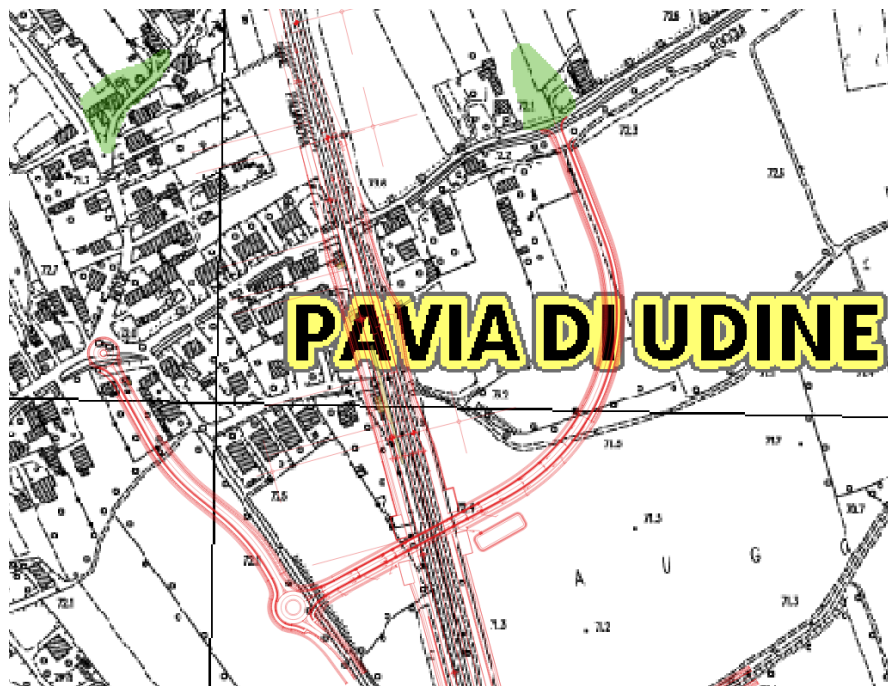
Stralcio del Piano di Assetto Idrogeologico – Area P1 in loc. Lumignacco
